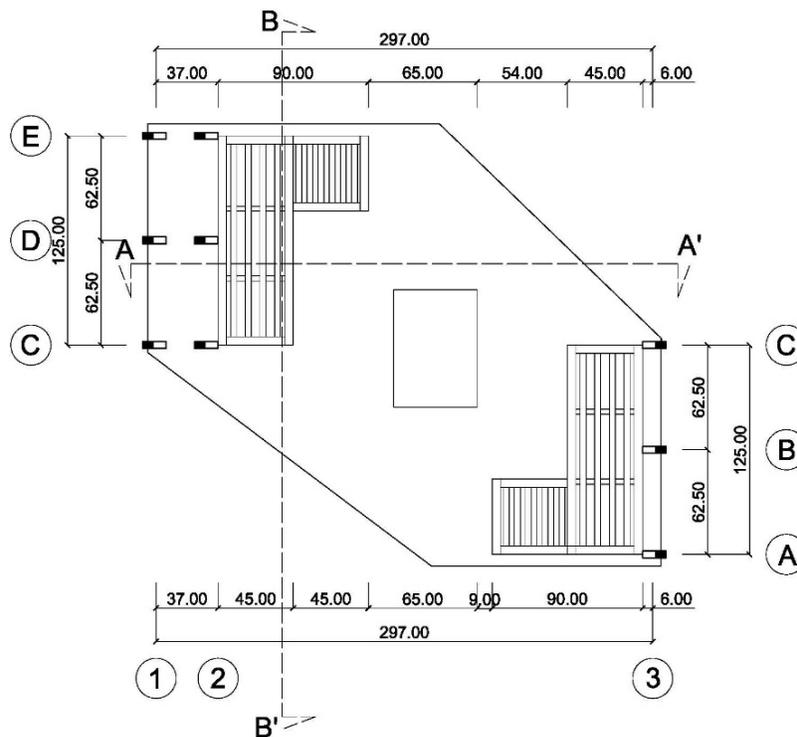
Site Plan Desain Ruang Interaksi Sosial
